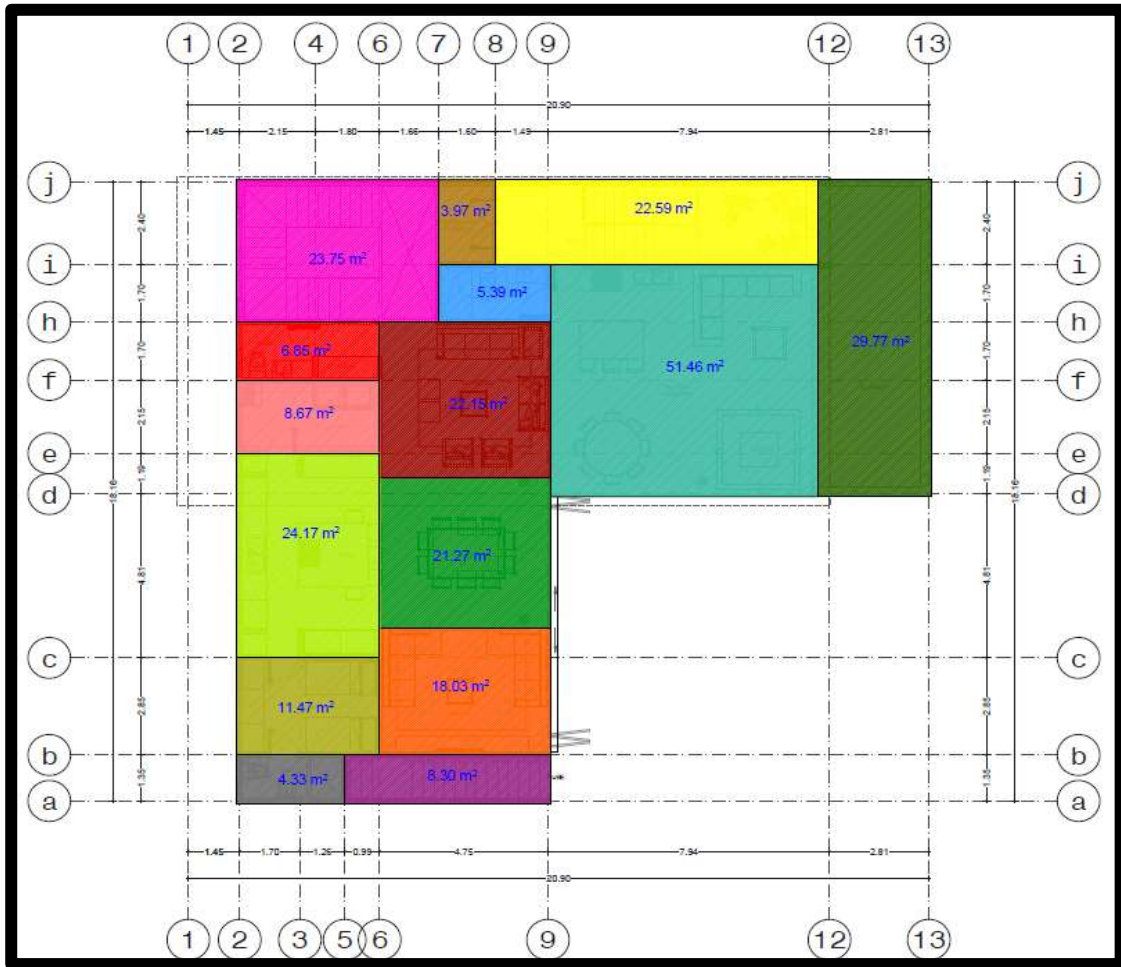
Distribución de áreas al interior de cada casa planta baja.
